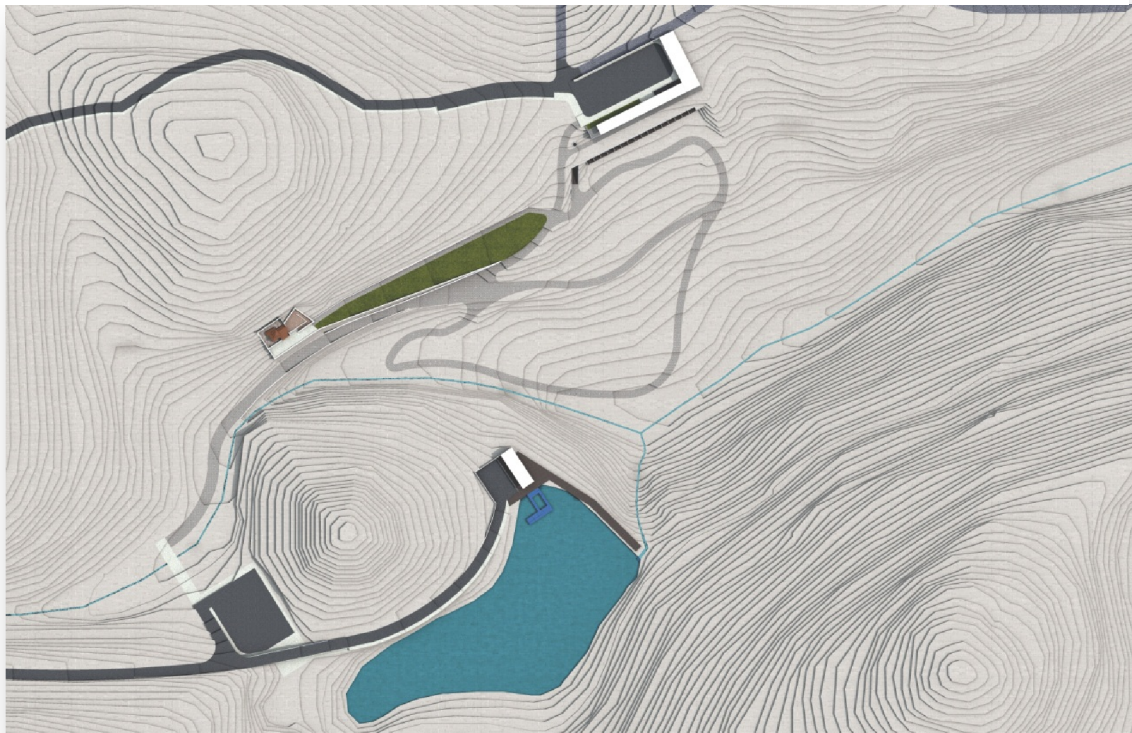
Imagem virtual da Planta Geral da proposta de intervenção; 1 – Pousada; 2 – Ermida de Nª Sª do Paraíso; 3 – Zona de apoio à barragem.
